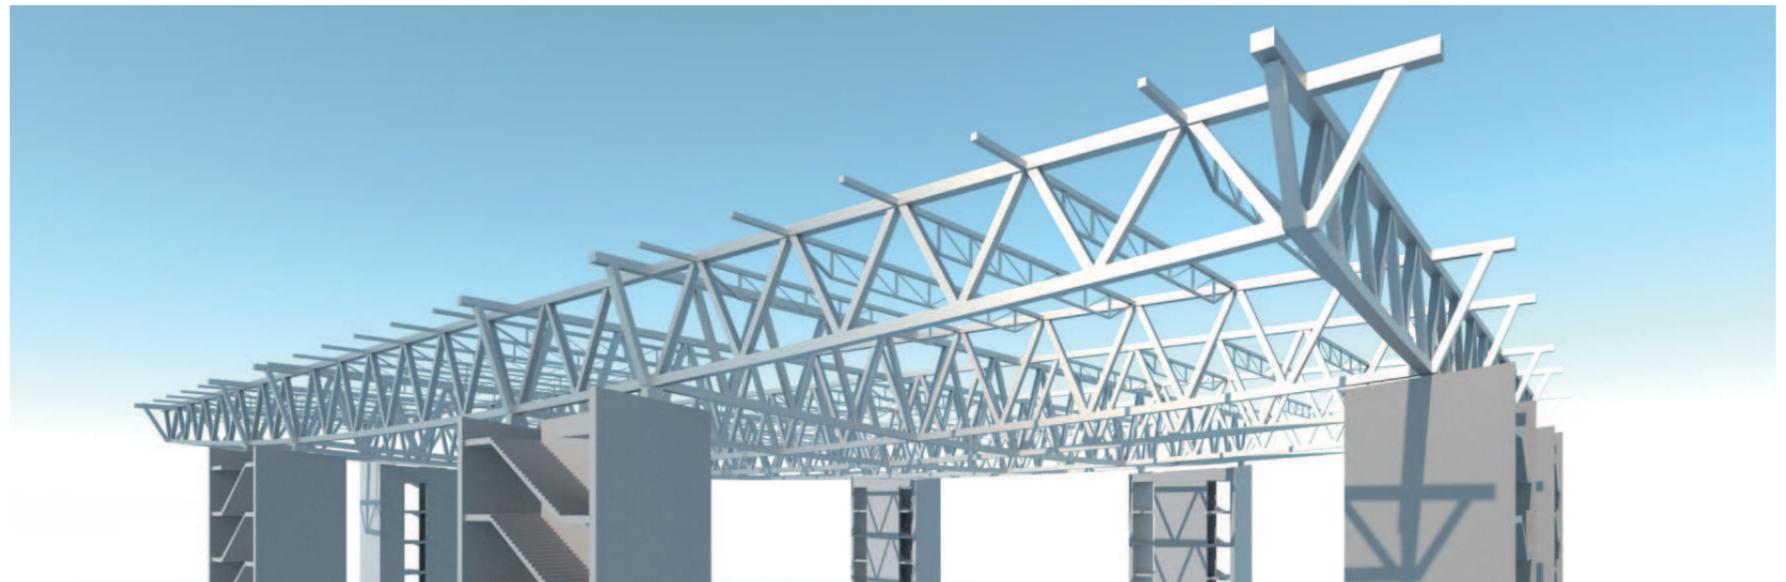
Bauablauf 5: Dach Fertigstellung des Daches kann die Fassade montiert werden. Das Gebäude ist nun Wetterfest, der Innenausbau kann beginnen.
